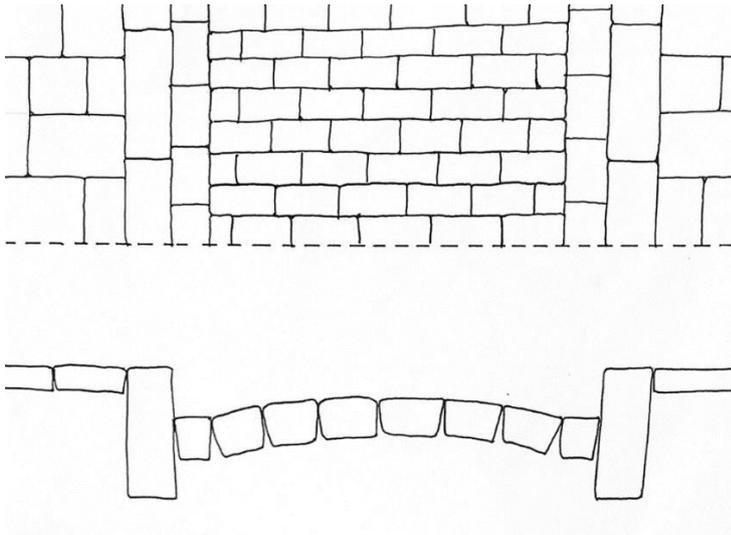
Boceto de planta y sección tipo de la pavimentación de rodano con aceras en las calles de Valencia.
